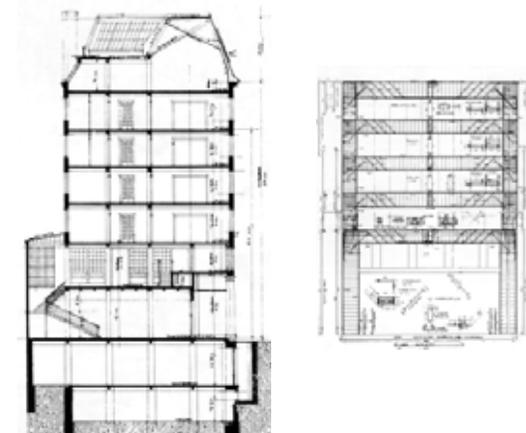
Edificio de viviendas en la Michaelerplatz, sección y plano de estructura de la fachada principal. Adolf Loos, Viena 1909-11.
